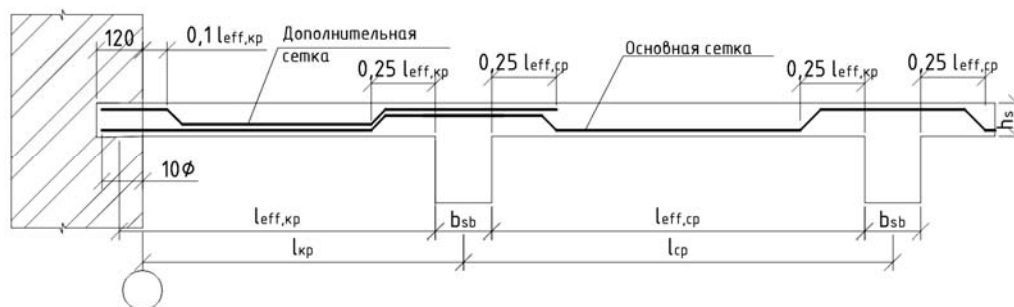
Схема армирования плиты сварными рулонными сетками
